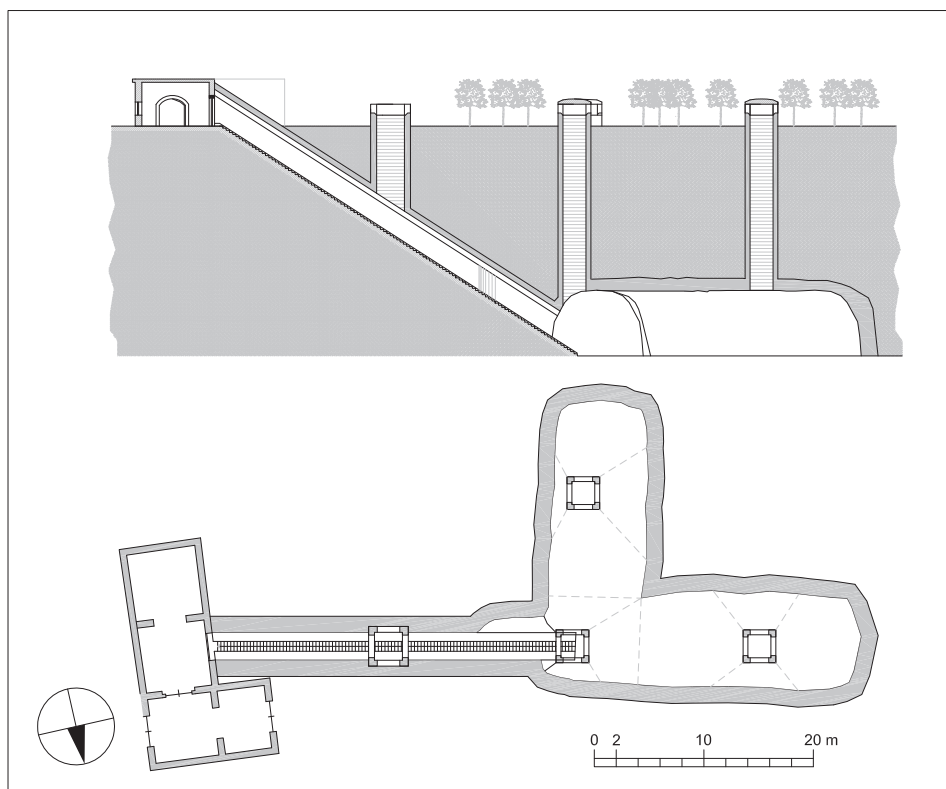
Comiziano, cantina C7. Pianta e sezione longitudinale.
